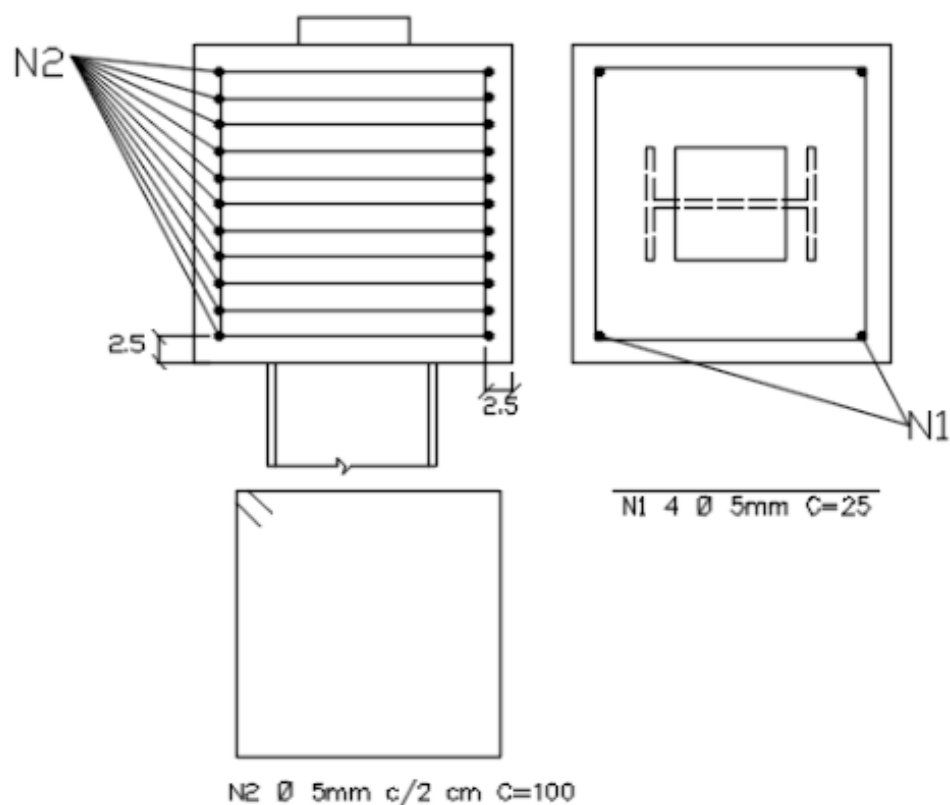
Detalhamento da armadura A2. Vista lateral e superior, Autores (2017).
